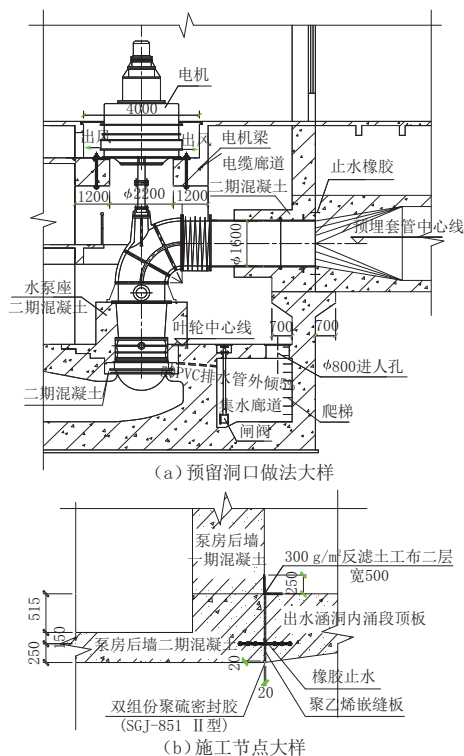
水泵出水管预留洞口施工工艺示意(单位:cm)
